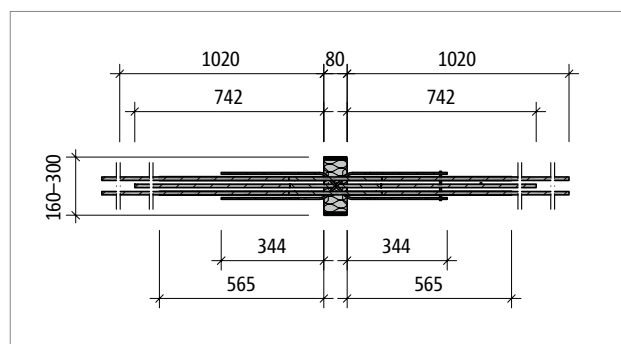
Schöck Isokorb® T type W-M4 : plan de base du produit
